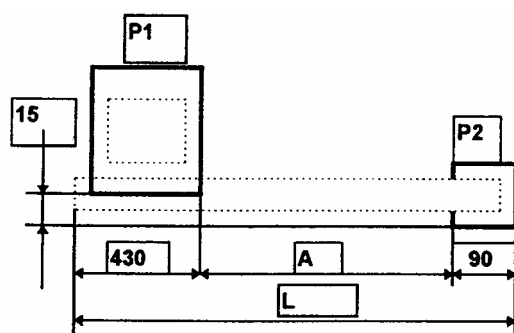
Эскиз для установки шлагбаума и неподвижной опоры.
